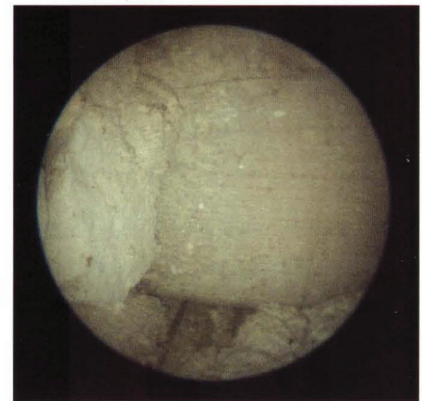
Observação boroscópica da entrega de uma das vigas do pavimento
